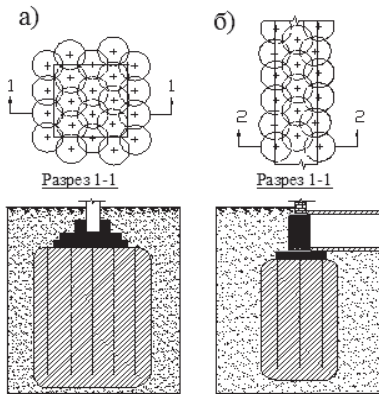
Схема сплошного закрепления грунта под фундаментами колонн (а) и несущих стен (б)
